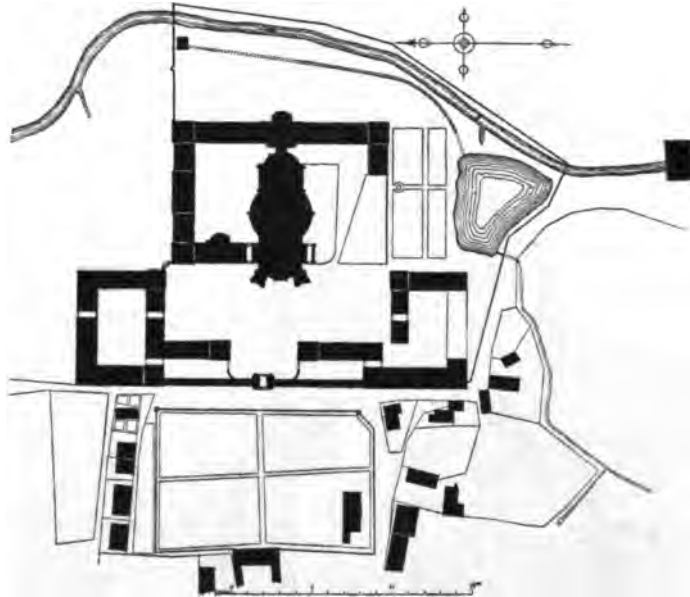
Lageplan des Klosters Wiblingen bei Ulm
